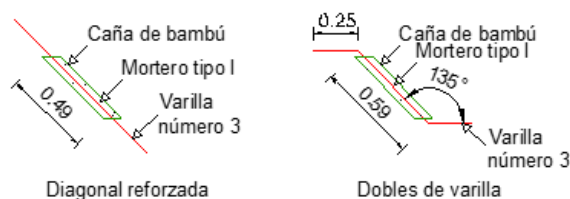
Geometría y detalles de armadura de bambú tipo Warren.
